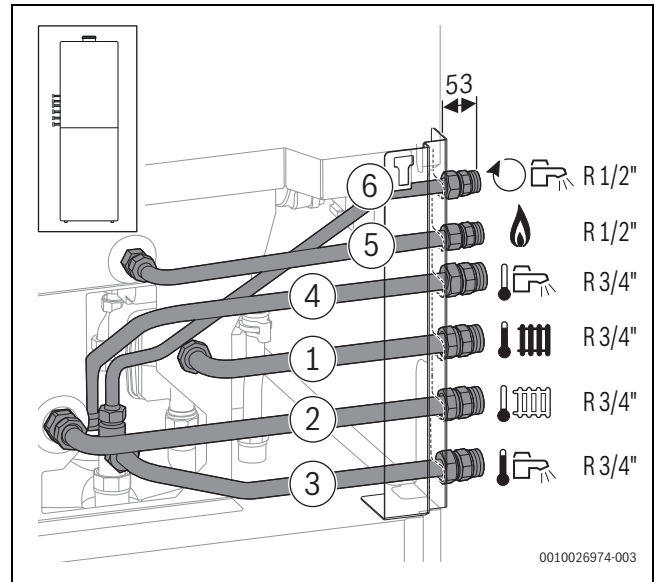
Vedere din spate (dimensiuni în mm): accesorii CS 10 montate pe partea stângă
